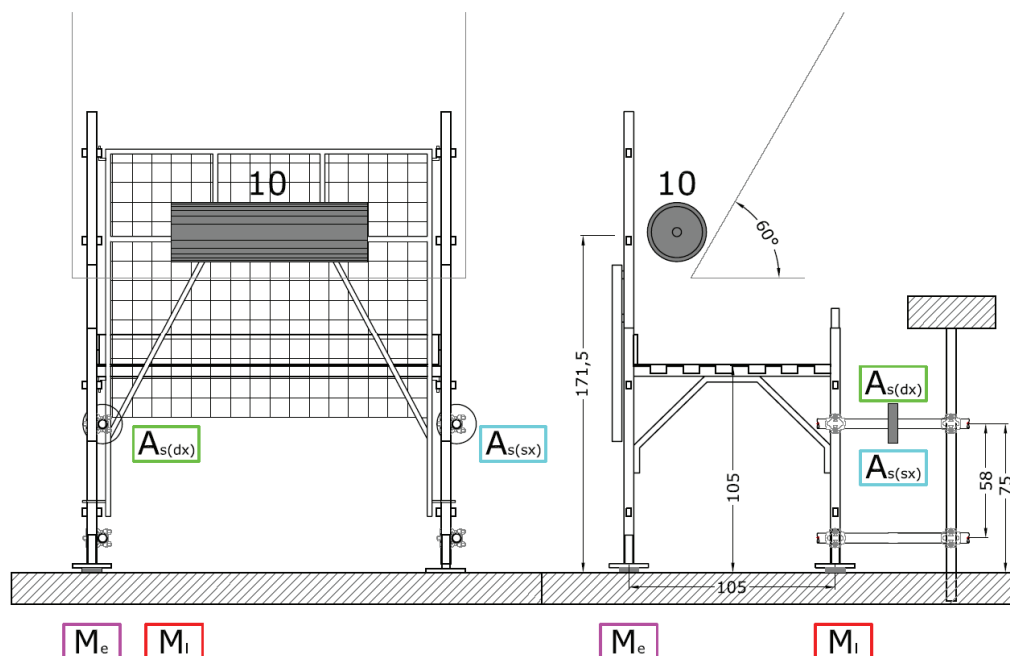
3 Prove d'impatto con rullo cilindrico su protezione continua – Schema CSR – Posizione degli strumenti di misura
